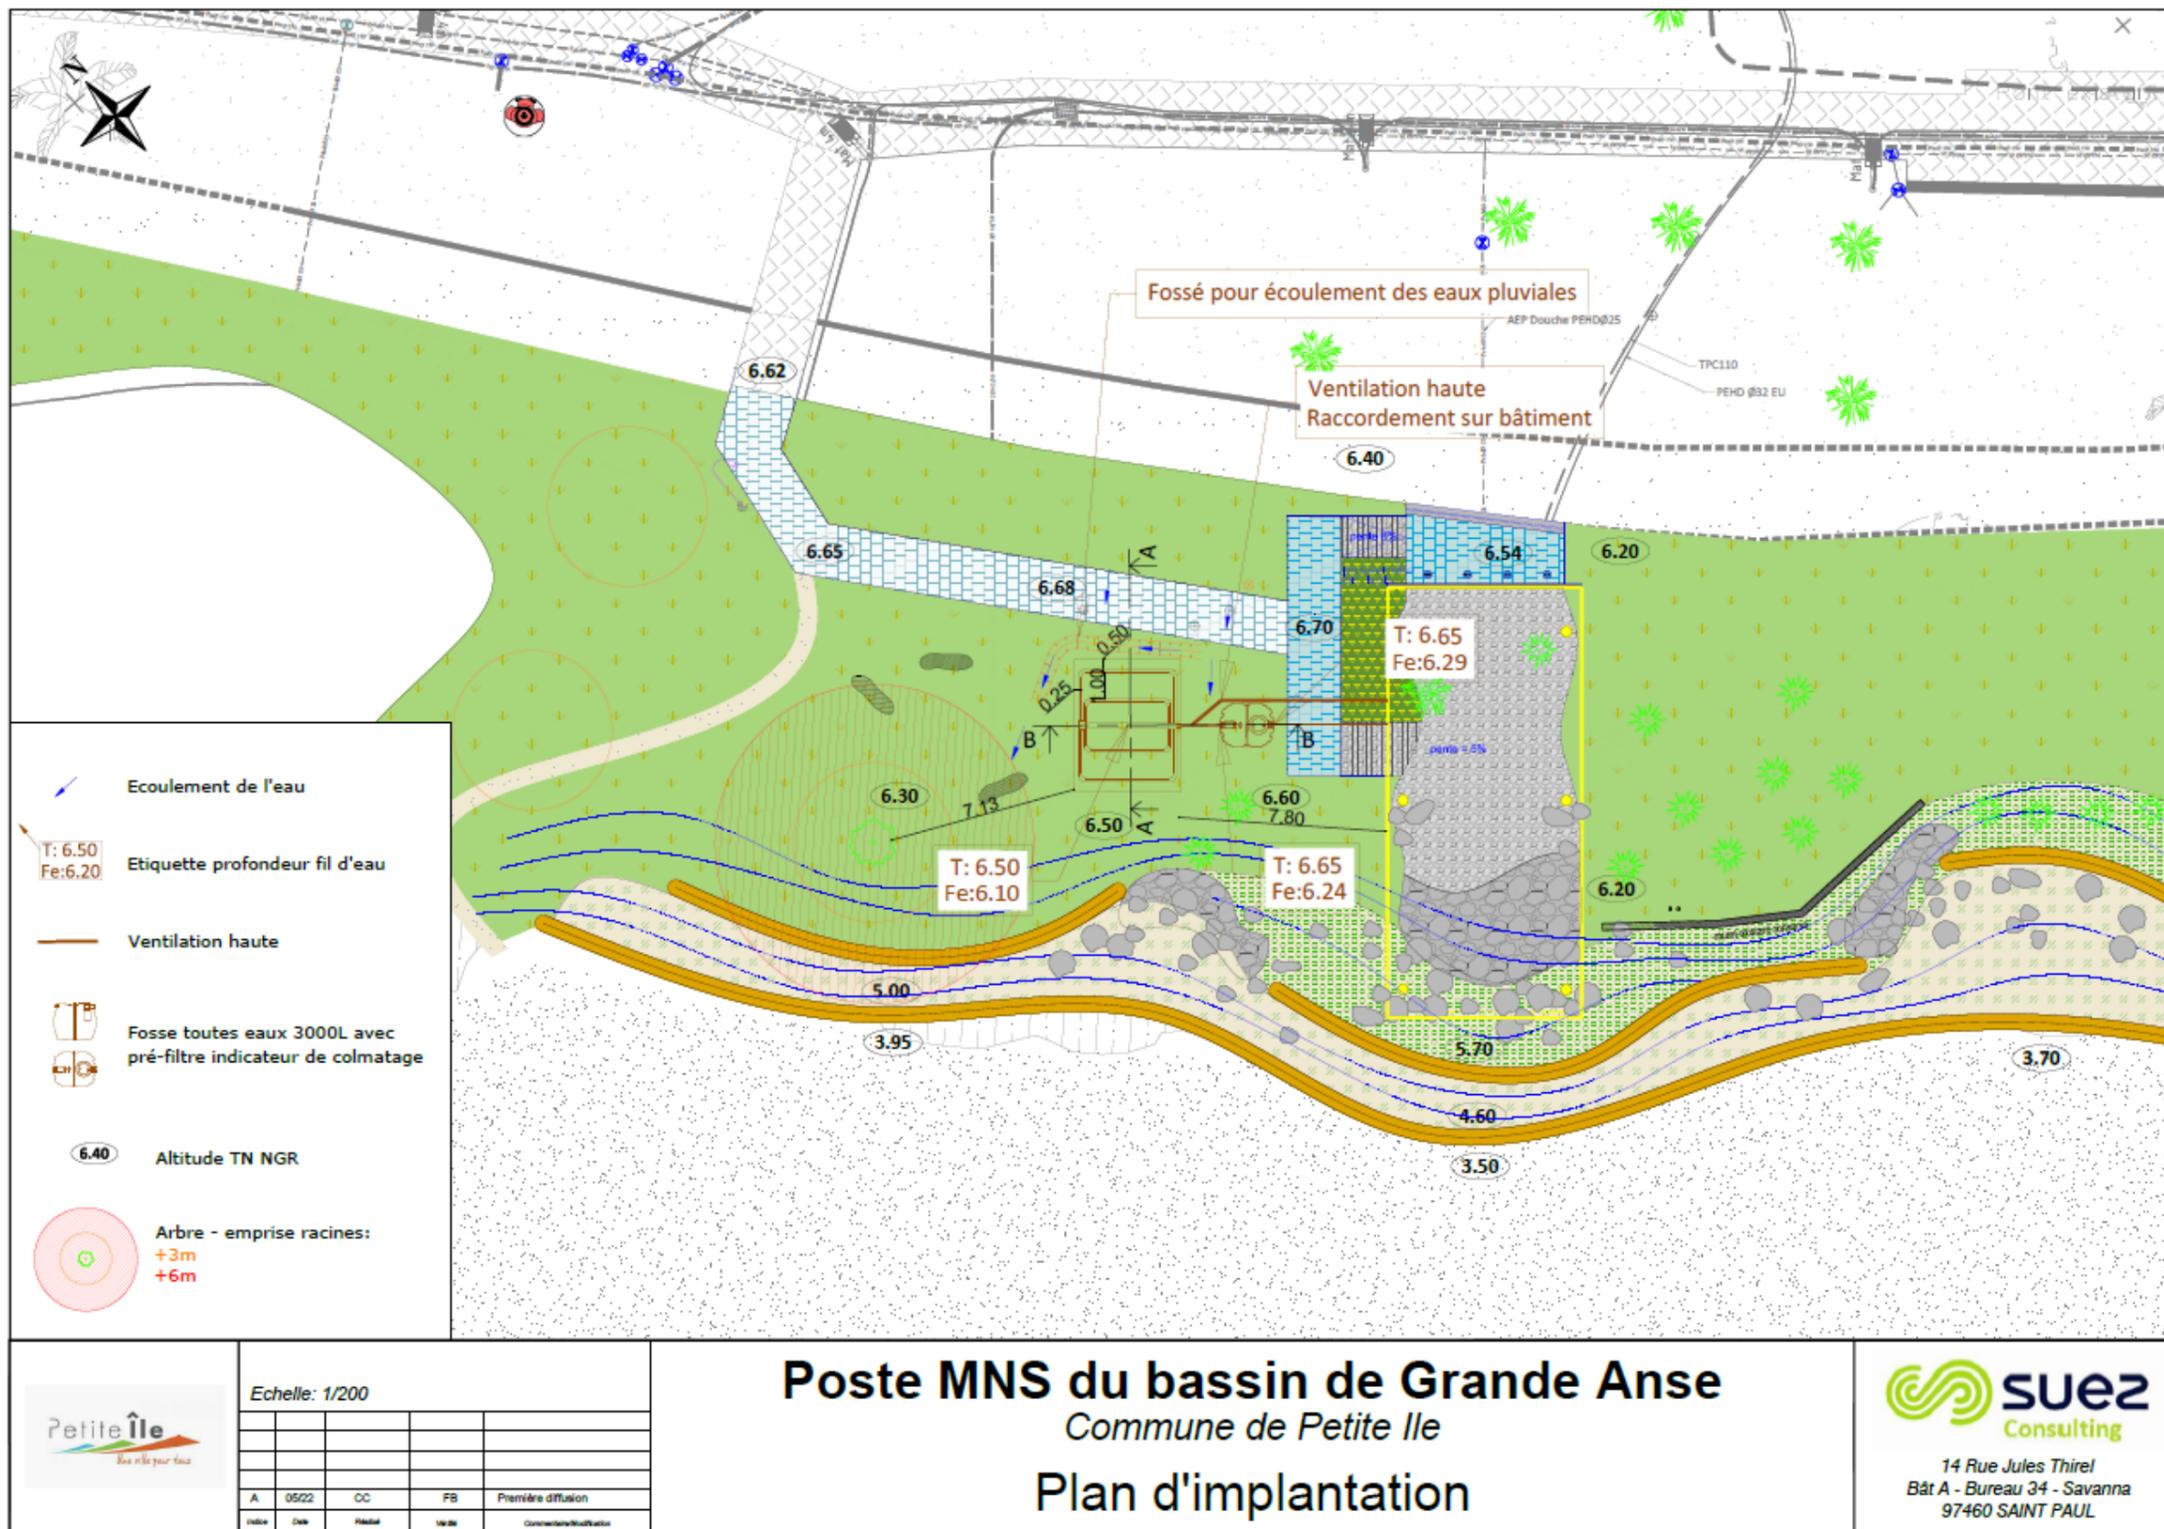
Plan d'implantation du système d'assainissement envisagé
